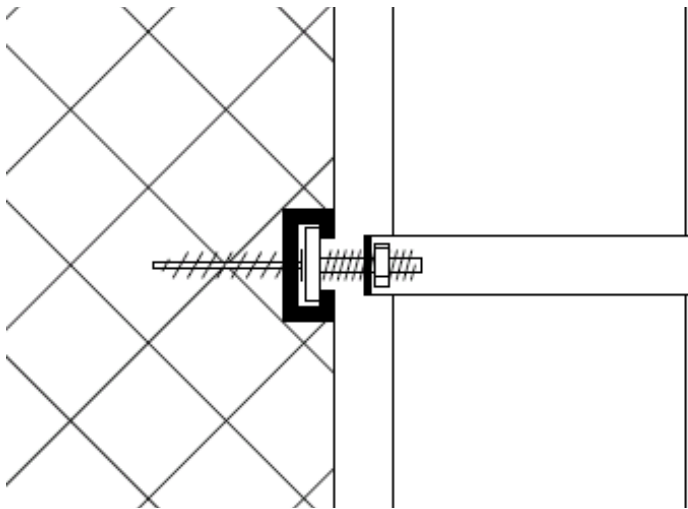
Detail Vertikalschnitt Montageschiene in Betonwand Steigzone
